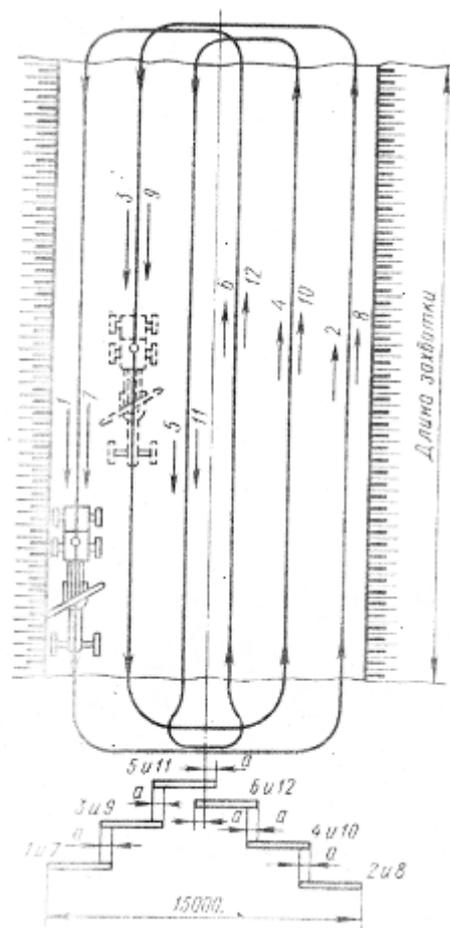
Послойное разравнивание грунта насыпи круговыми проходами:
